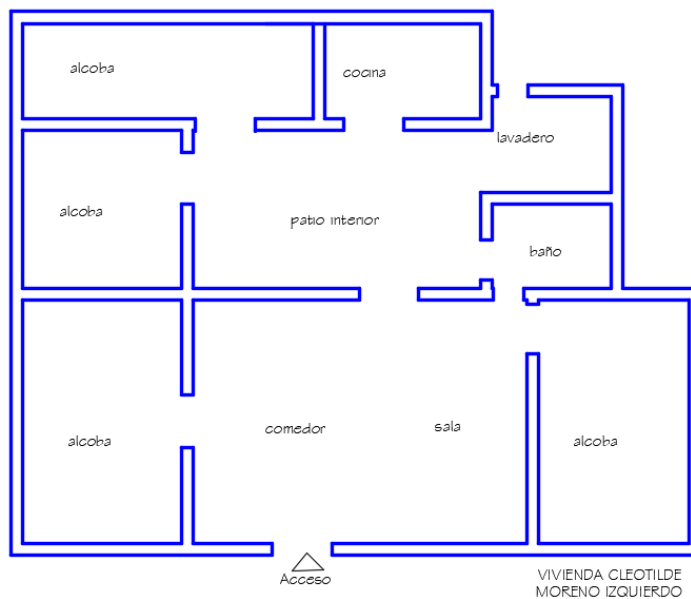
Esquema planta arquitectónica Vivienda Cleotilde Moreno. Elaboración propia
